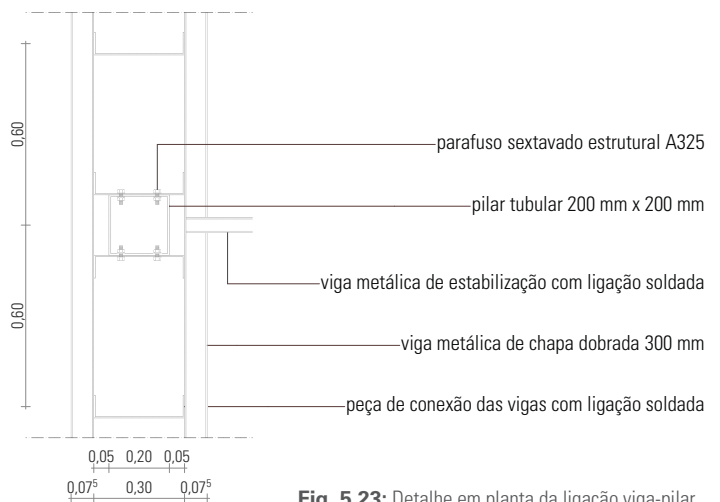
Detalhe em planta da ligação viga-pilar.
